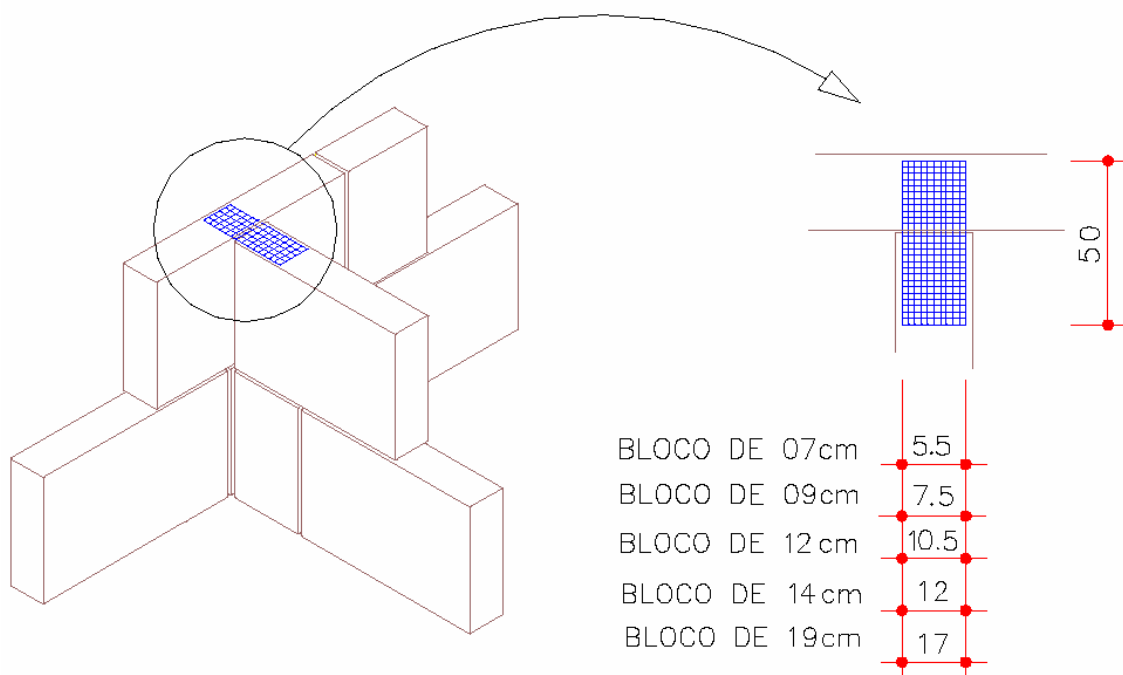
Detalhe de ligação entre paredes empregando tela metálica
